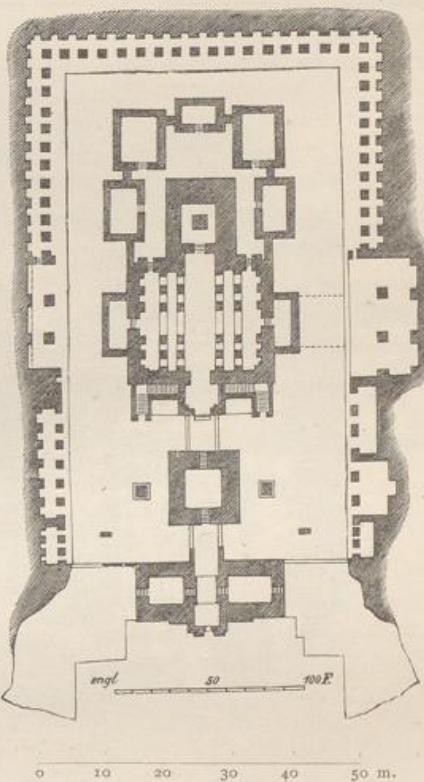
Kailasa zu Ellora. Grundriss.
